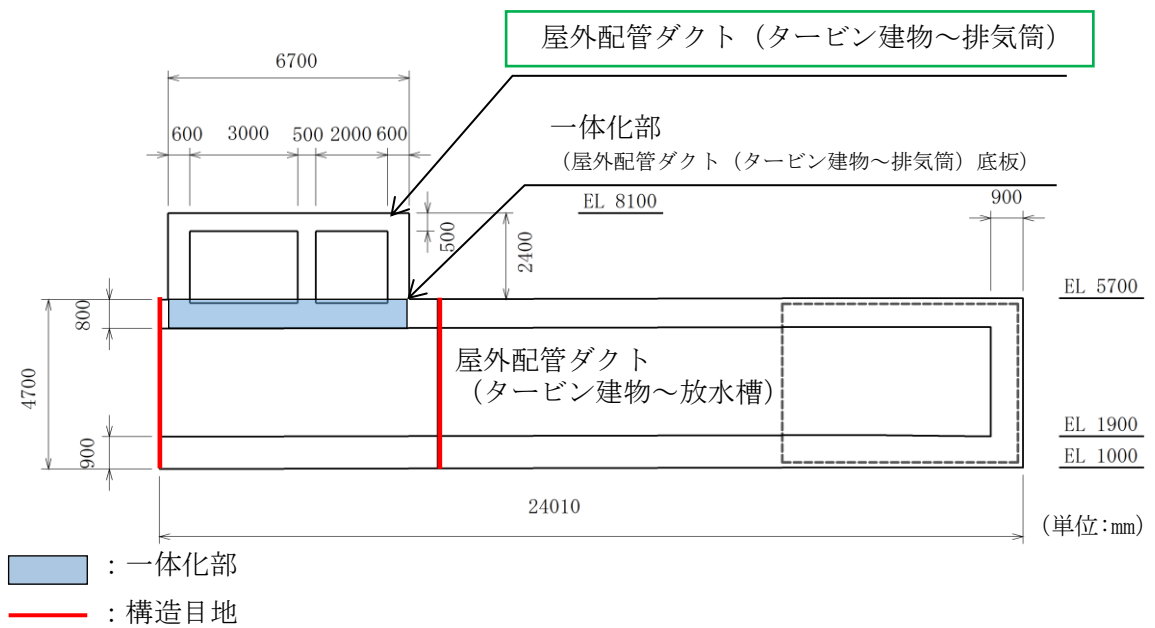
屋外配管ダクト (タービン建物～排気筒) 断面図 (B-B断面)
